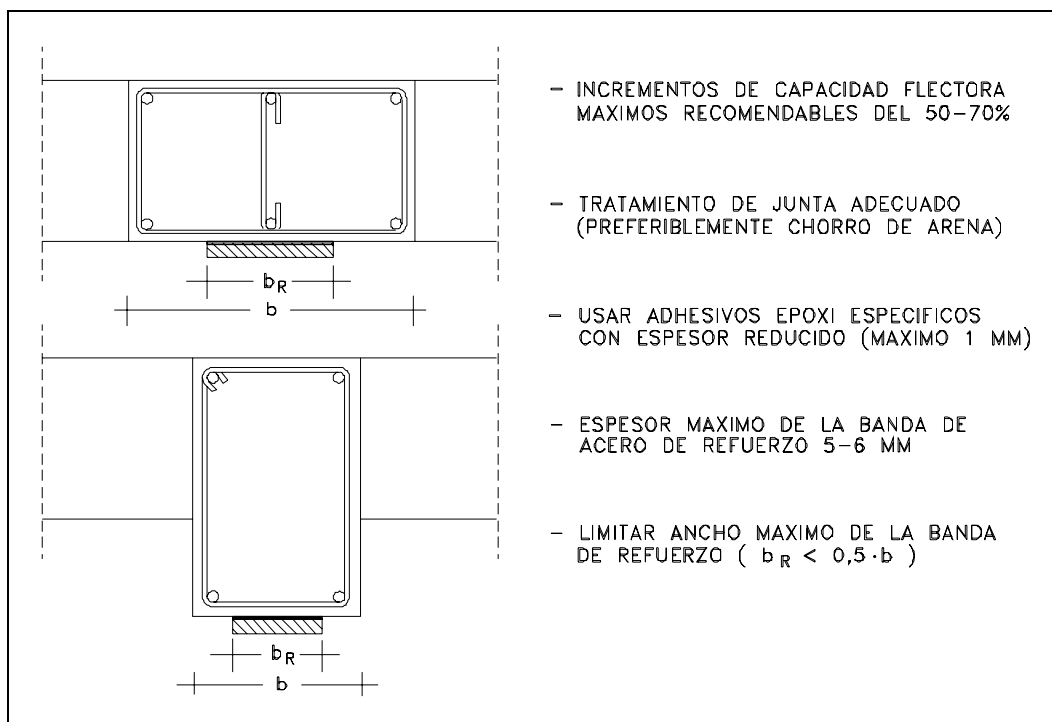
Refuerzo de vigas mediante bandas de acero encoladas con adhesivos epoxi
